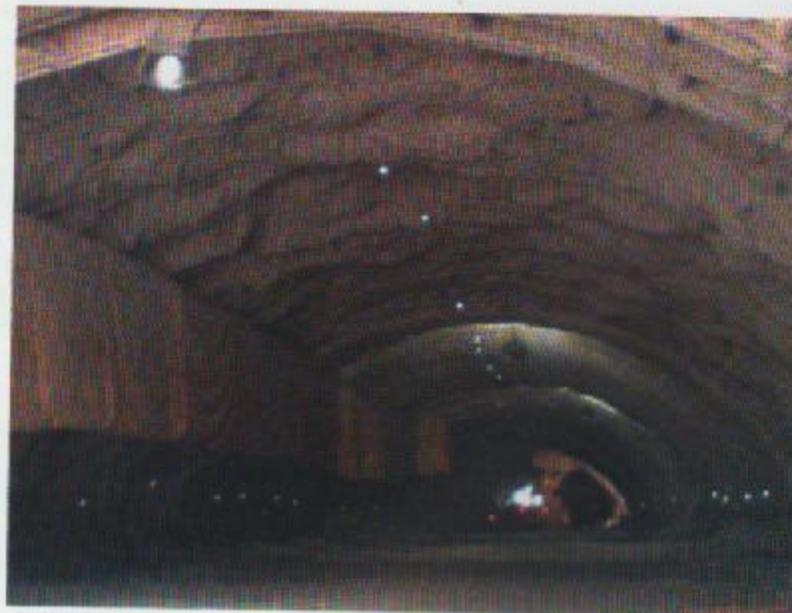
Concreto lanzado con fibra helicoidal para recubrimiento de túneles.
